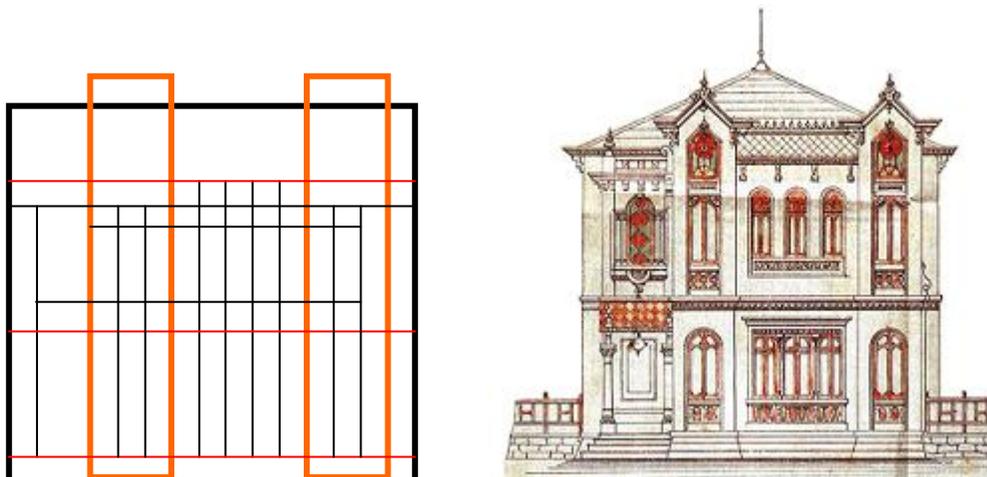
e 85: Notam-se as linhas verticais dominando o traçado da composição da fachada
